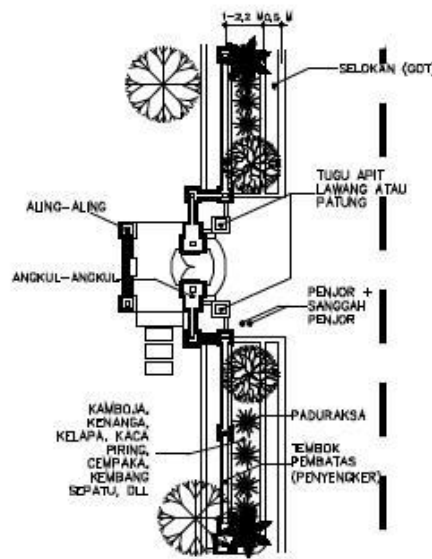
Layout, Dimensions and Elements of Telajakan¹
